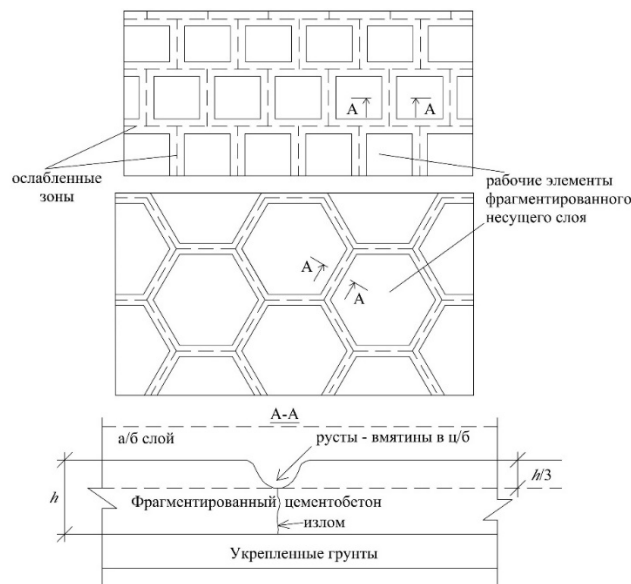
План и поперечный разрез фрагментированного несущего слоя
